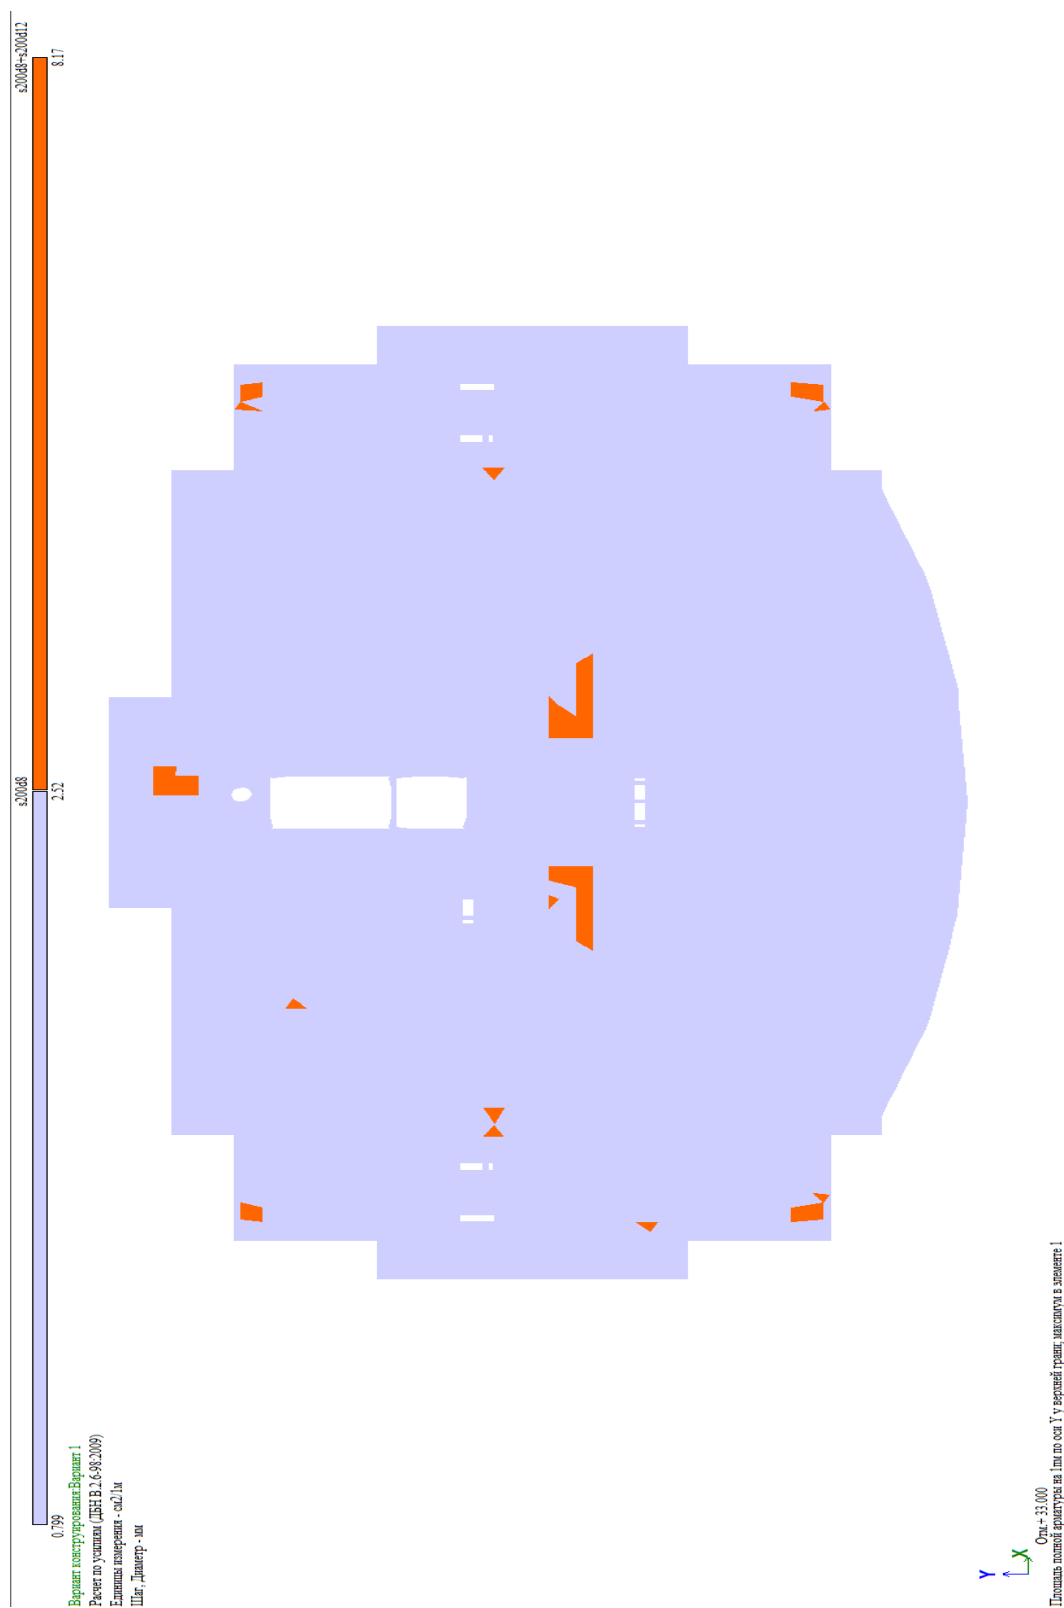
Розташування поздовжньої арматури по осі У у верхній зоні
